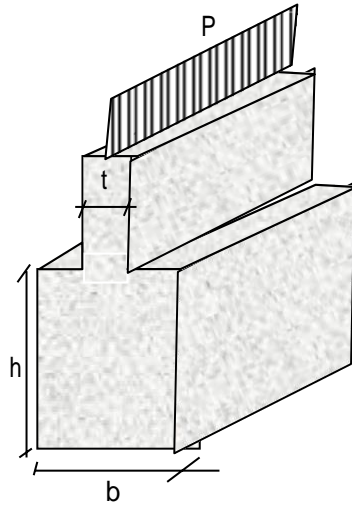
Diseño de viga de cimentación VC-02 en memoria de cálculo.
